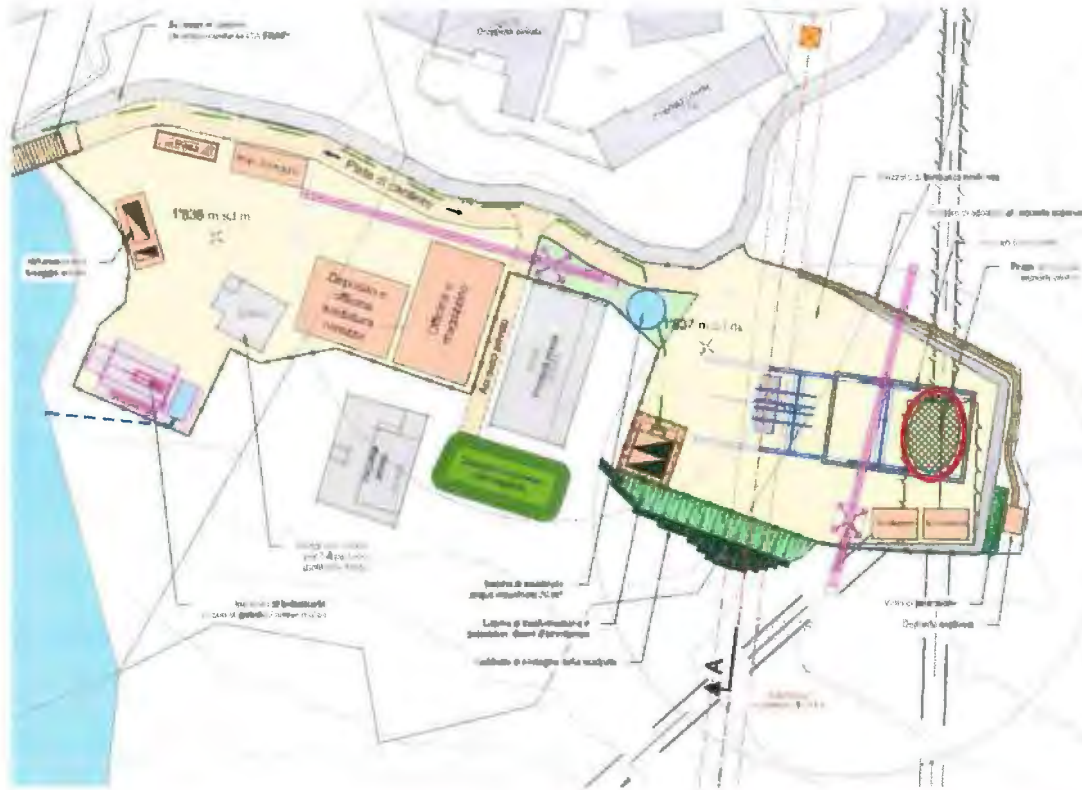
estratto planimetrico delle installazioni di cantiere a Piora (in rosso è evidenziato il nuovo accesso alla camera valvole).
